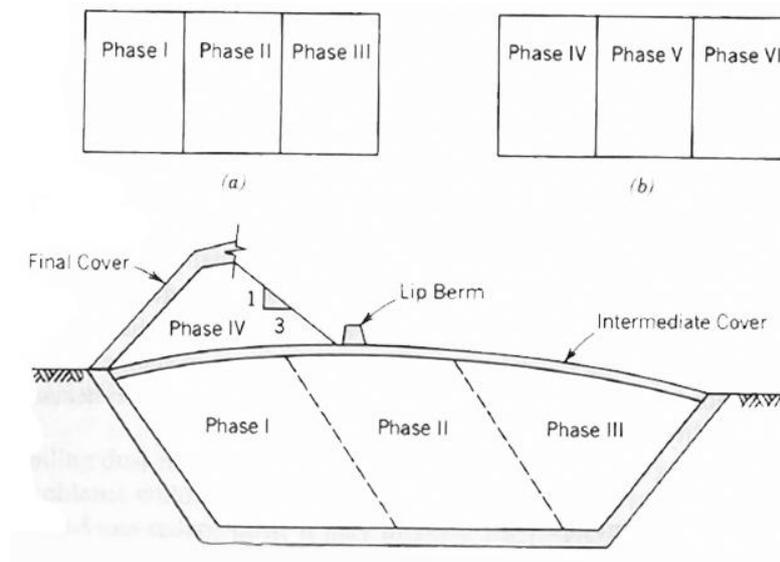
Plan de explotación de un vertedero multi-fase. (a) Planta de la fase inferior; (b) Planta de la fase superior y sección en el dibujo principal. (Bagchi, 1990)
